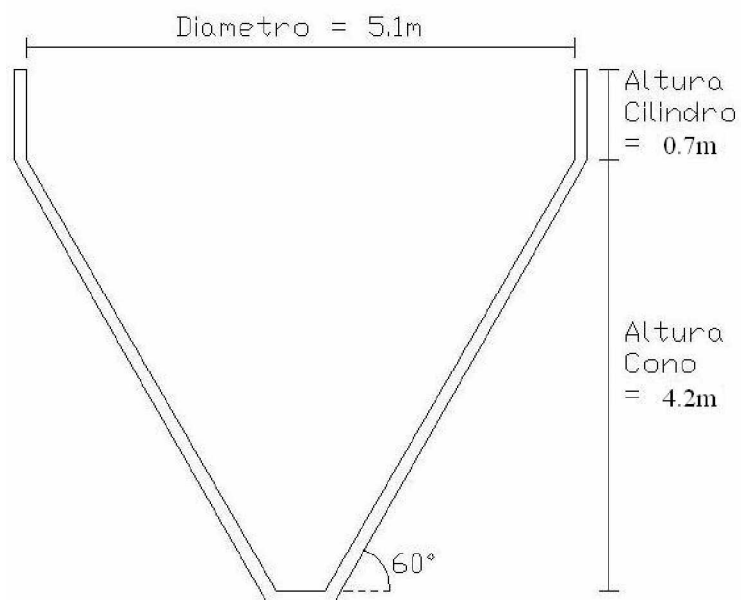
Sección del sedimentador secundario para la Planta N°1
